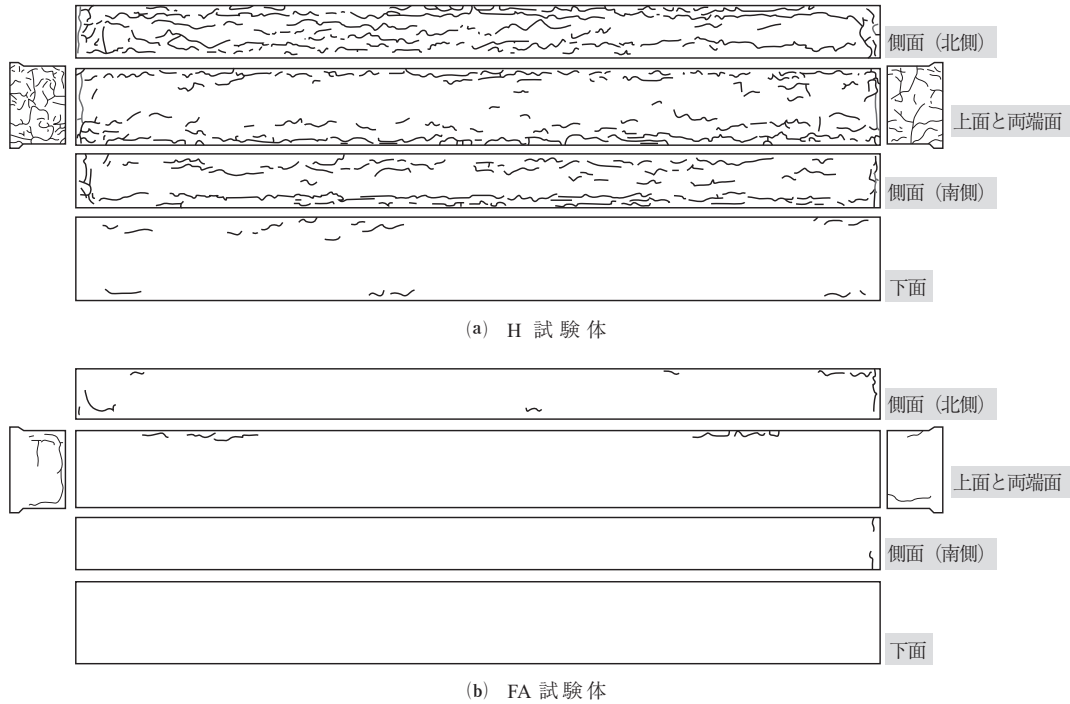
暴露試験体の ASR ひび割れ展開図
